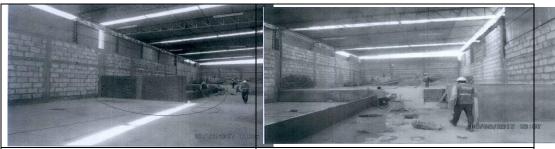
Vista Fotografica del interior de la Foto N°05: Vista Fotografica del interior de la Planta
